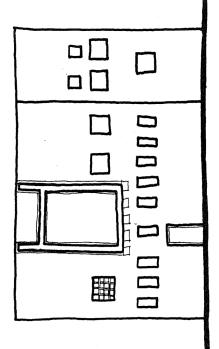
منزل أبو همام الدور الأرضى المستوى الثاني - مسقط أفقى
